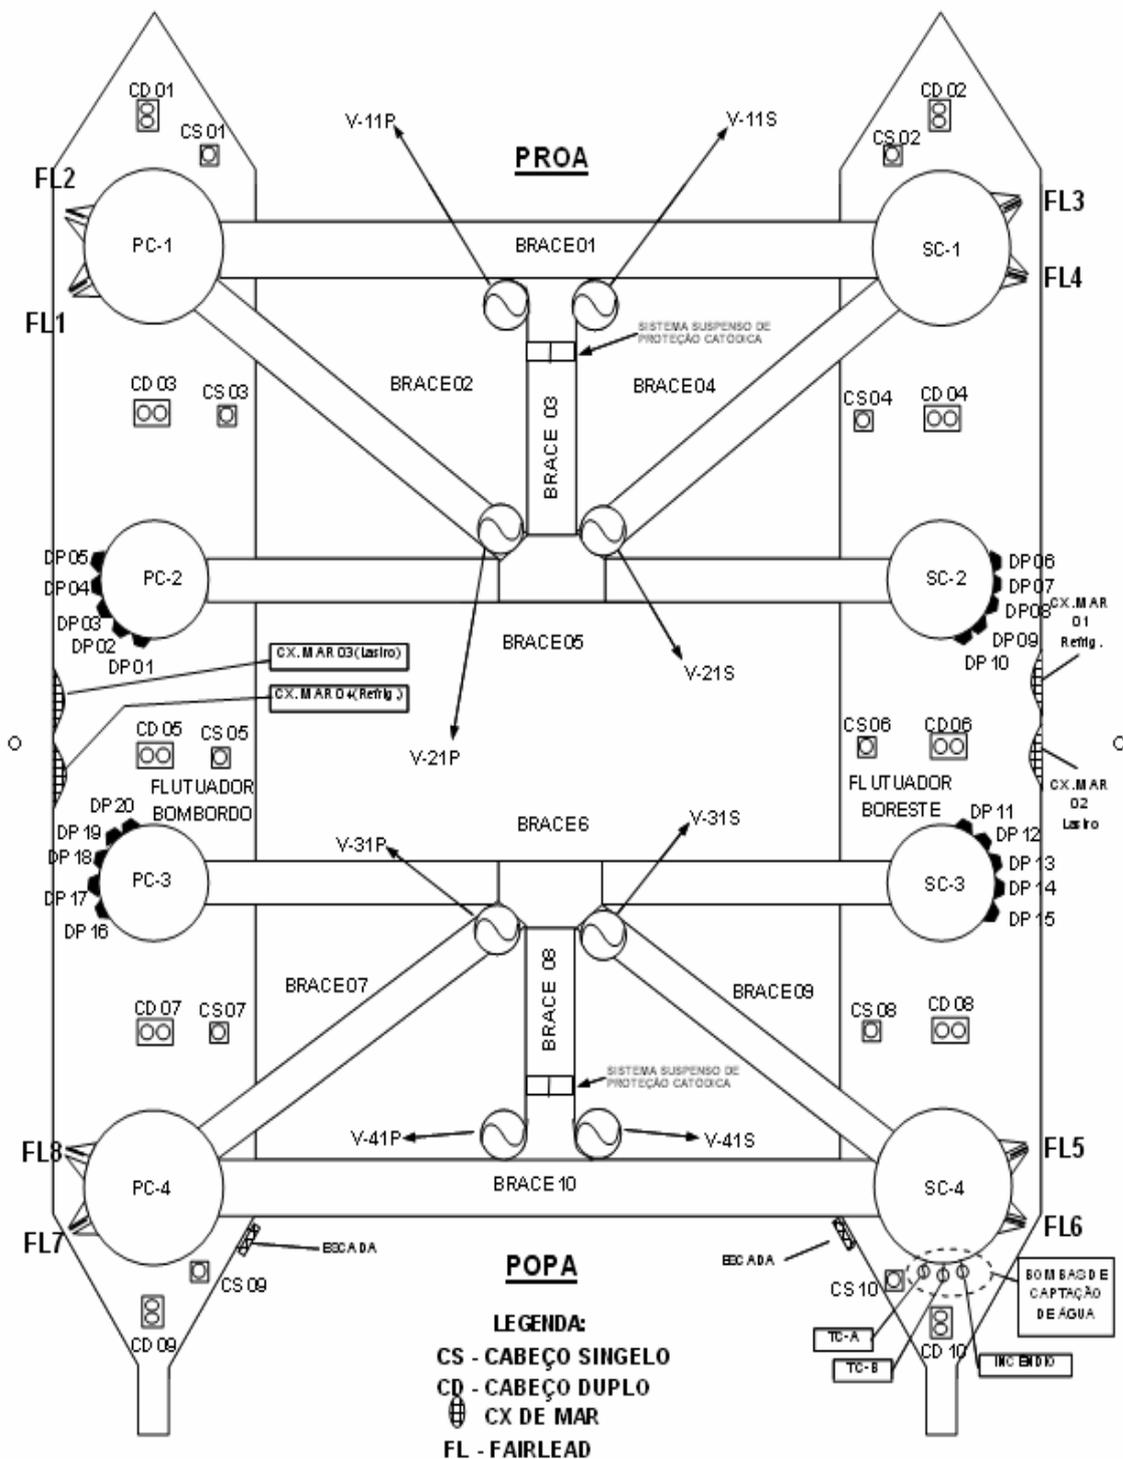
Plataforma P-15 / Arranjo geral das estruturas submersas e localização do *bracing* 03 (proa) e *bracing* 08 (popa) onde foram fixados por meio de braçadeiras os 2 conjuntos anodo/ER Zn.
